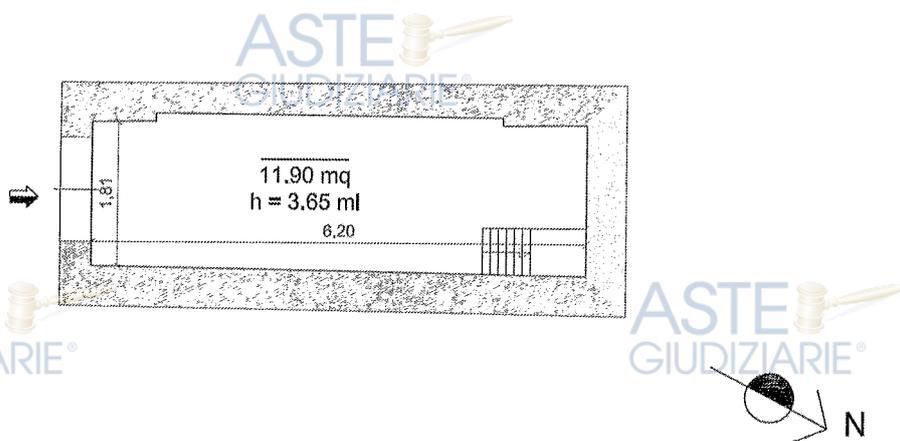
Planimetria Catastale Foglio 47, p.lla 1393, sub 1 – Piano Terra
